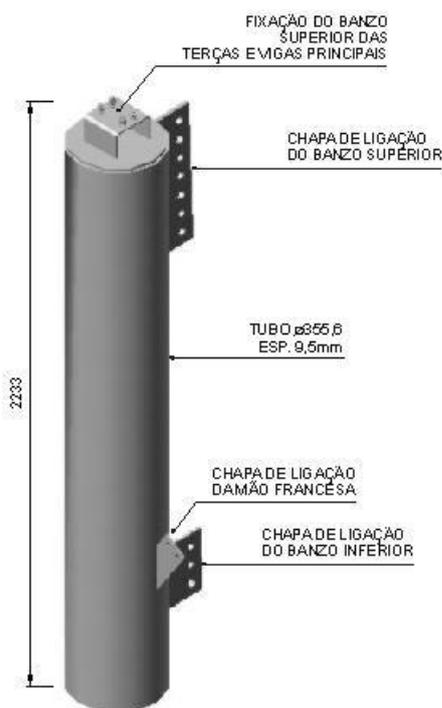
Pilarete para uso em pilares metálicos. Fonte: V&M do Brasil, 2005.
